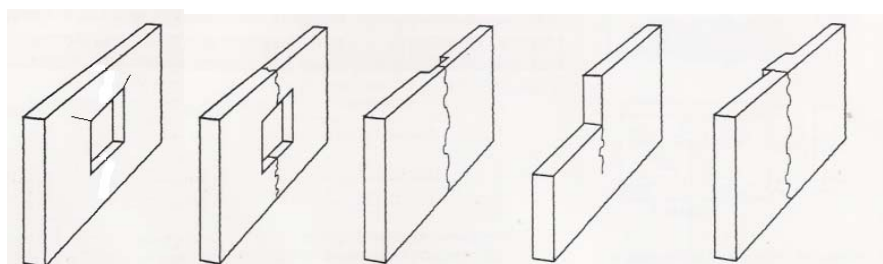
Diferentes exemplos de fissuras por aplicação de cargas localizadas.
